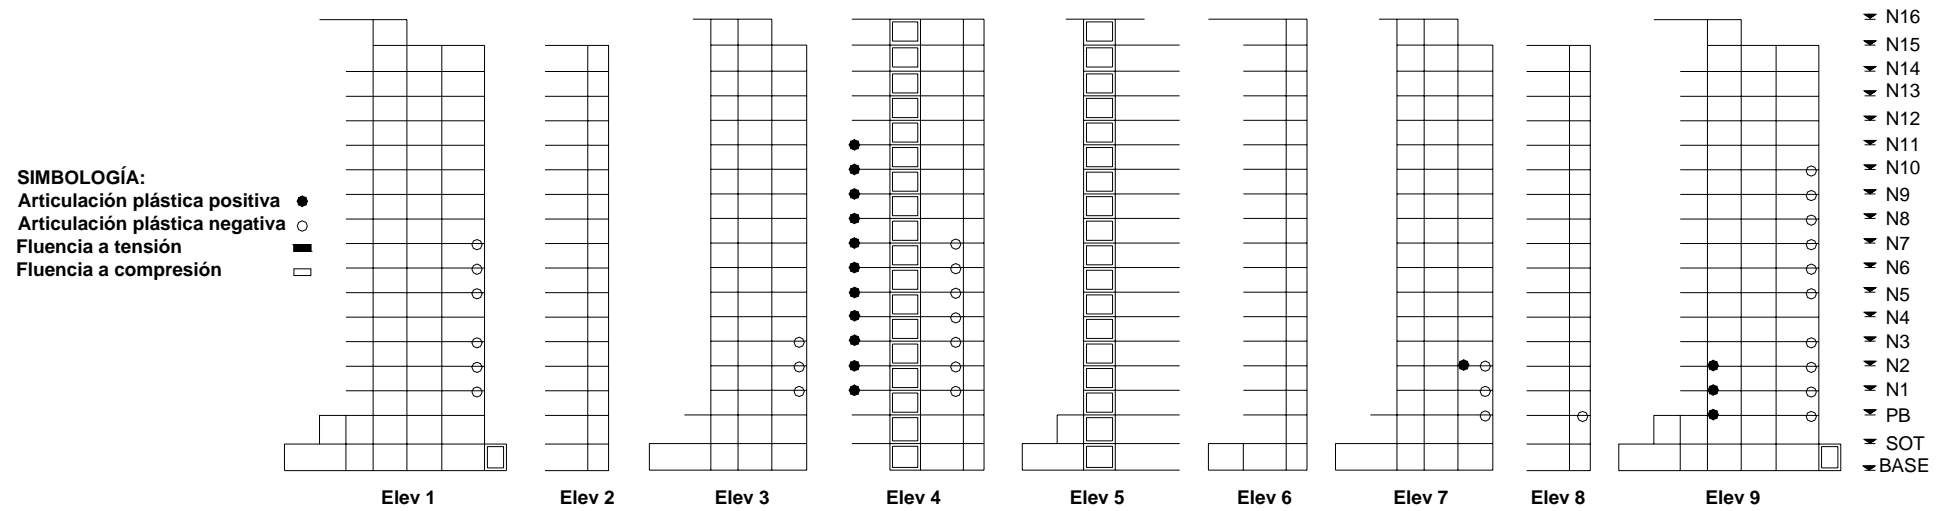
Formación de articulaciones plásticas en vigas y columnas para la SIM64 a los 53.53 s
